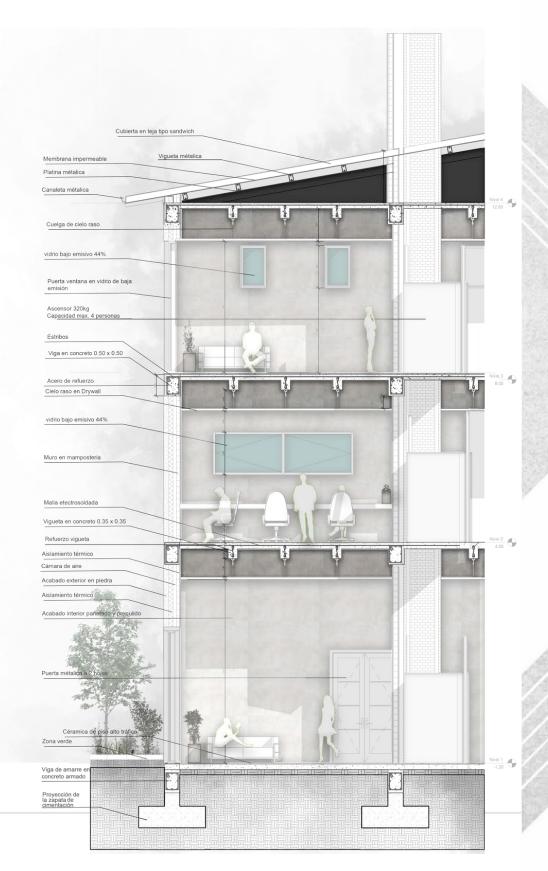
Corte por fachada. Fuente: Moreira, 2022.
